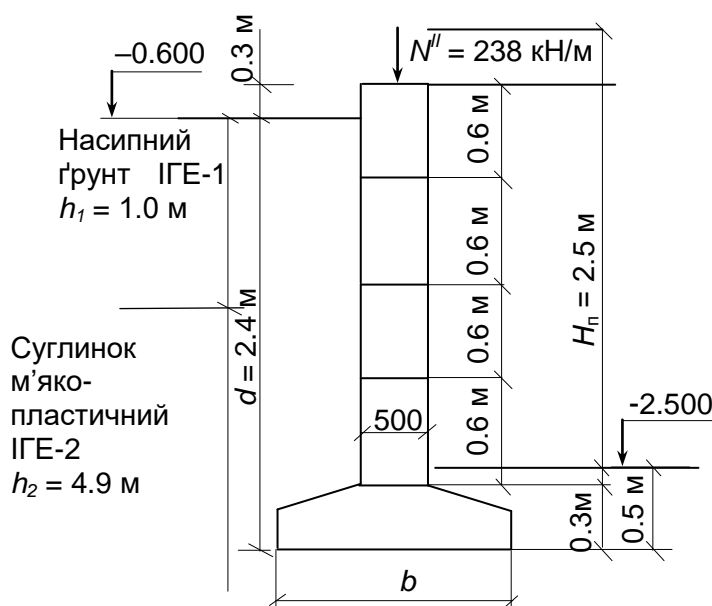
Розрахункова схема перерізу фундаменту в підвальній частині будинку
